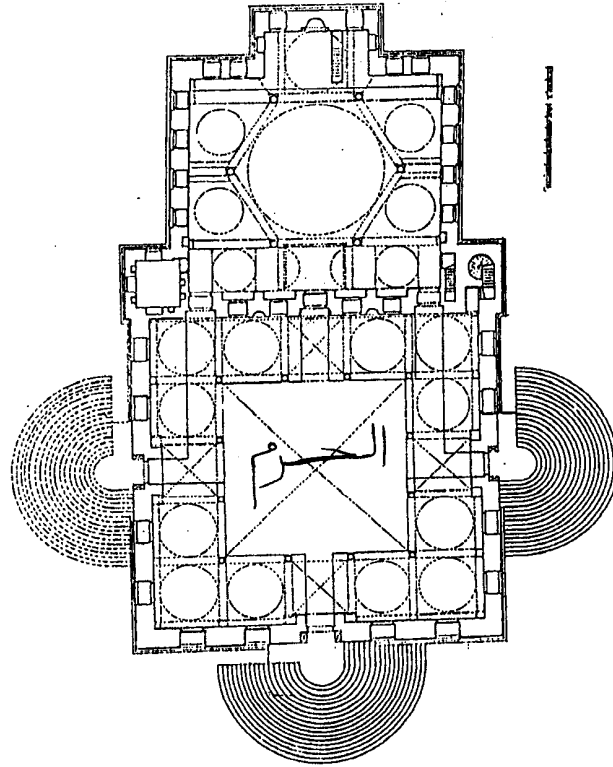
مسقط أفقي لجامع يخشي بك في تيره (عن Aslanapa)
